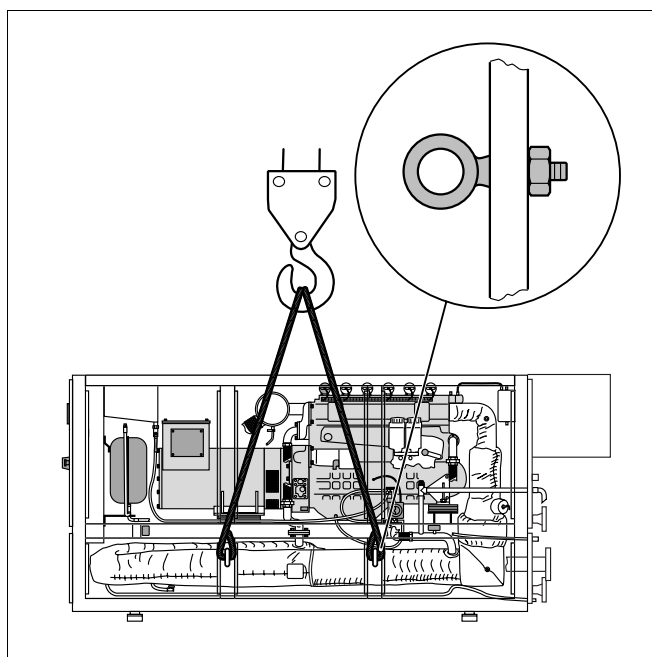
Doprava na místo instalace jeřábem za použití popruhů
